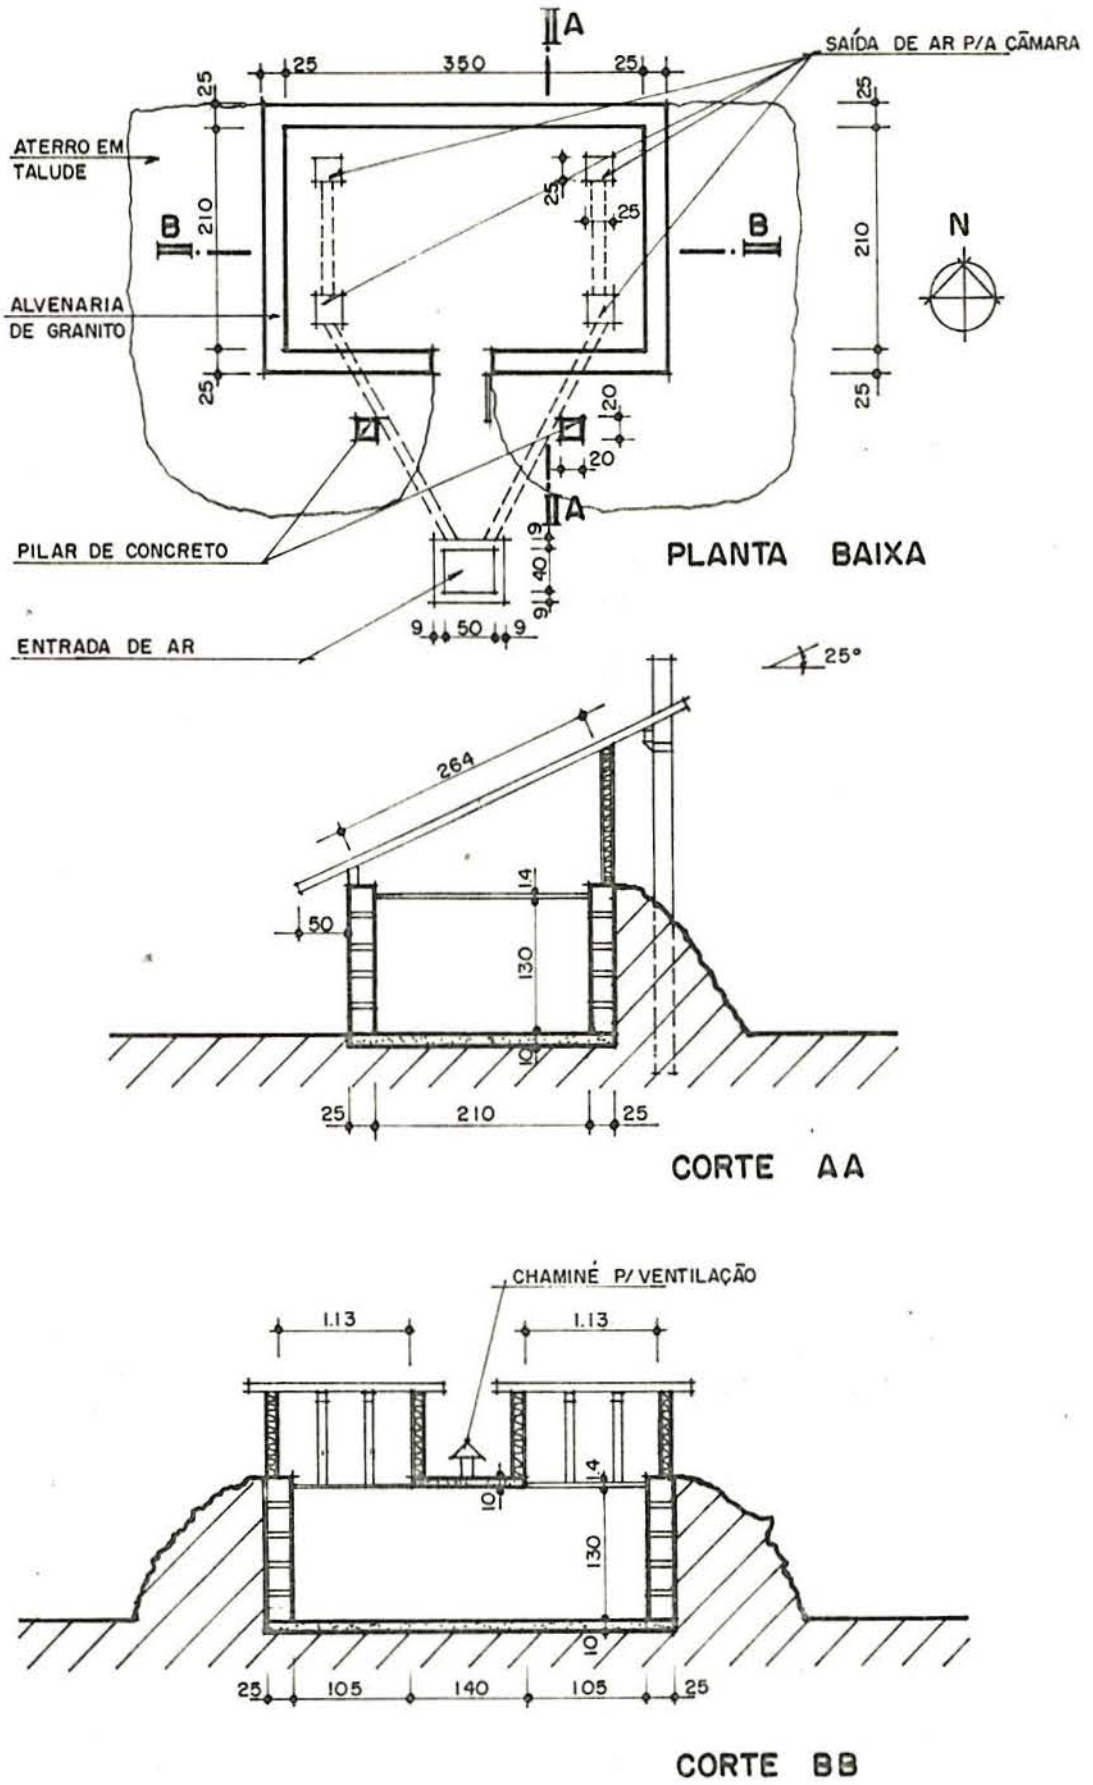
Planta baixa e cortes da bancada de testes.
